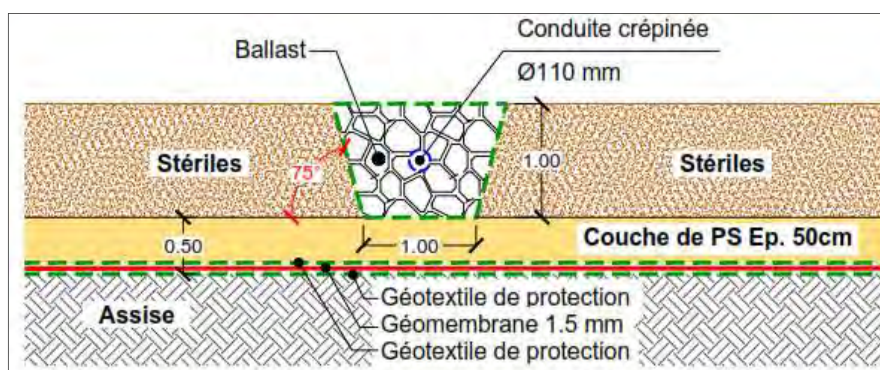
Coupe type du drain de collecte des eaux d'infiltration
